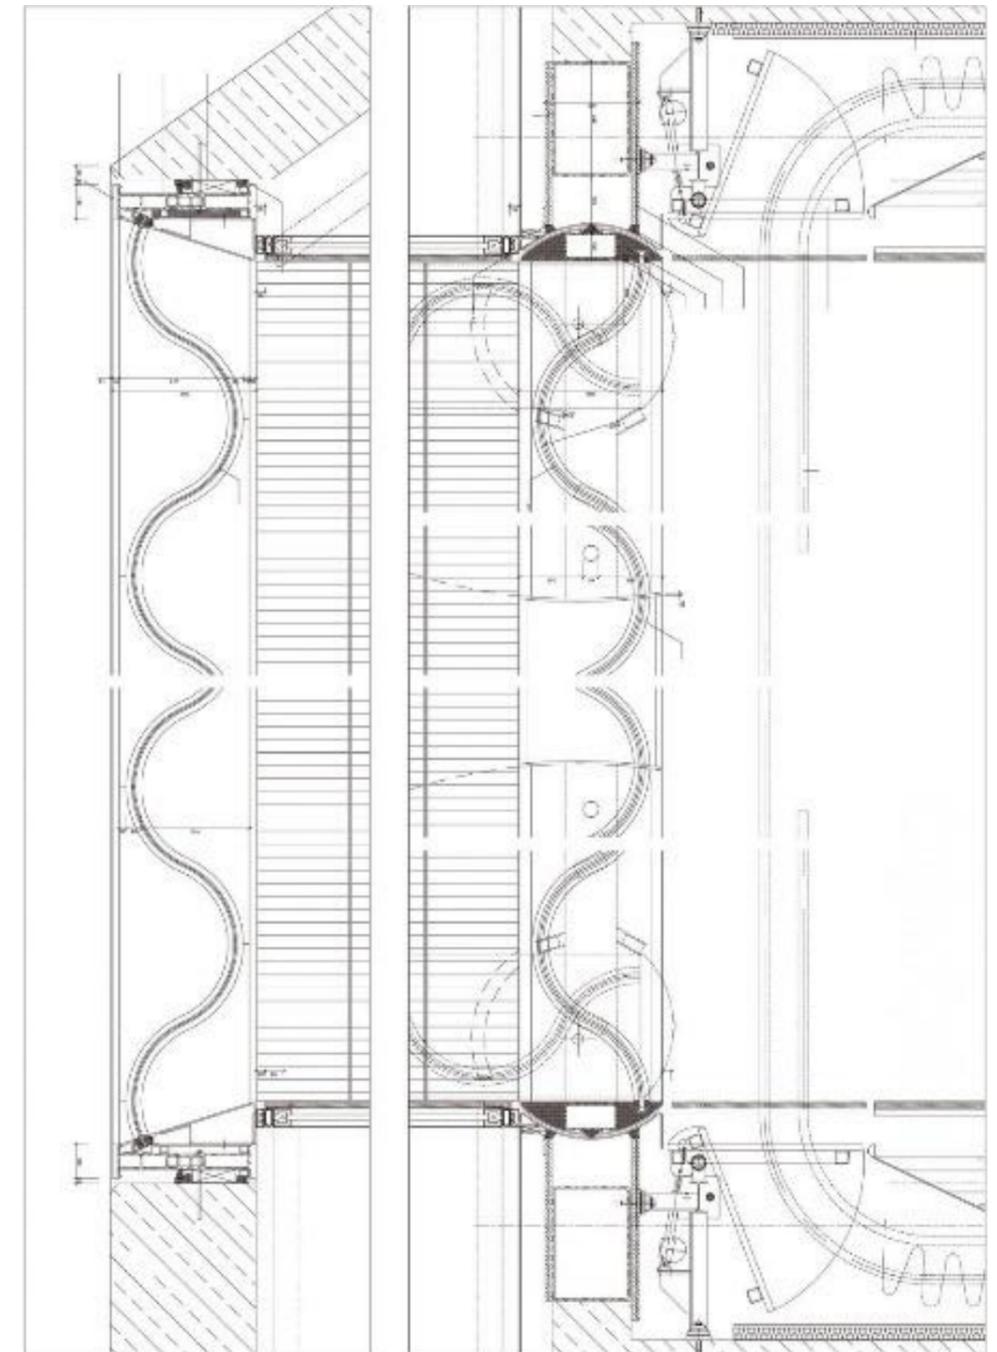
Planta constructiva del muro de vidrio ondulado. Donde destaca el encuentro con los muros de HA y la ausencia de montantes verticales
